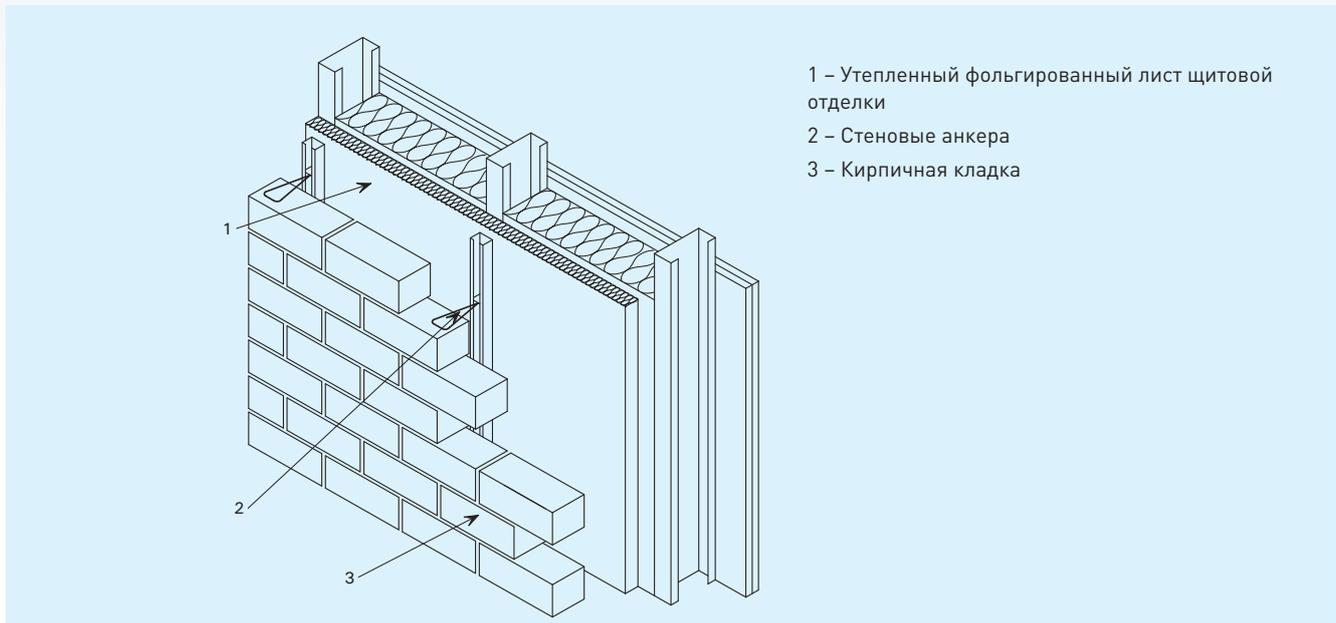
Фасадная стена с кирпичной кладкой
